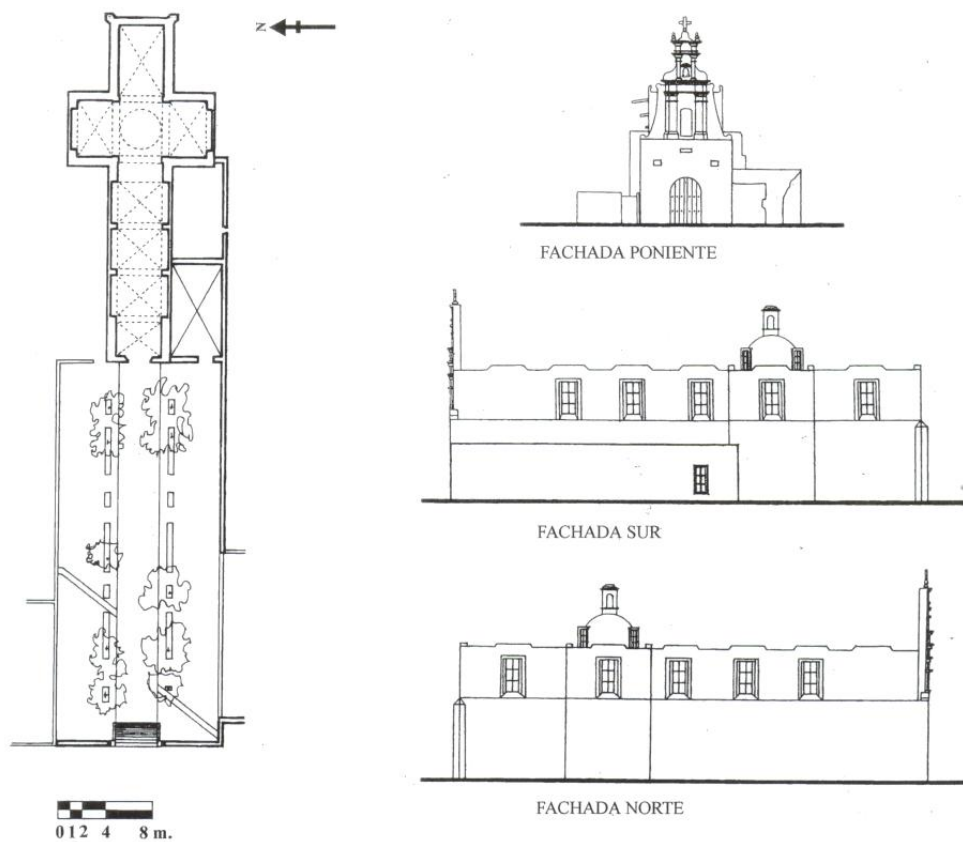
Planta arquitectónica e isometría de la Capilla de Santa Ana, las más elaborada de las capillas de barrio y la más alejada del monasterio; el barrio donde se encuentra que ahora es parte de Calpan, pudo haber estado separada de este.
